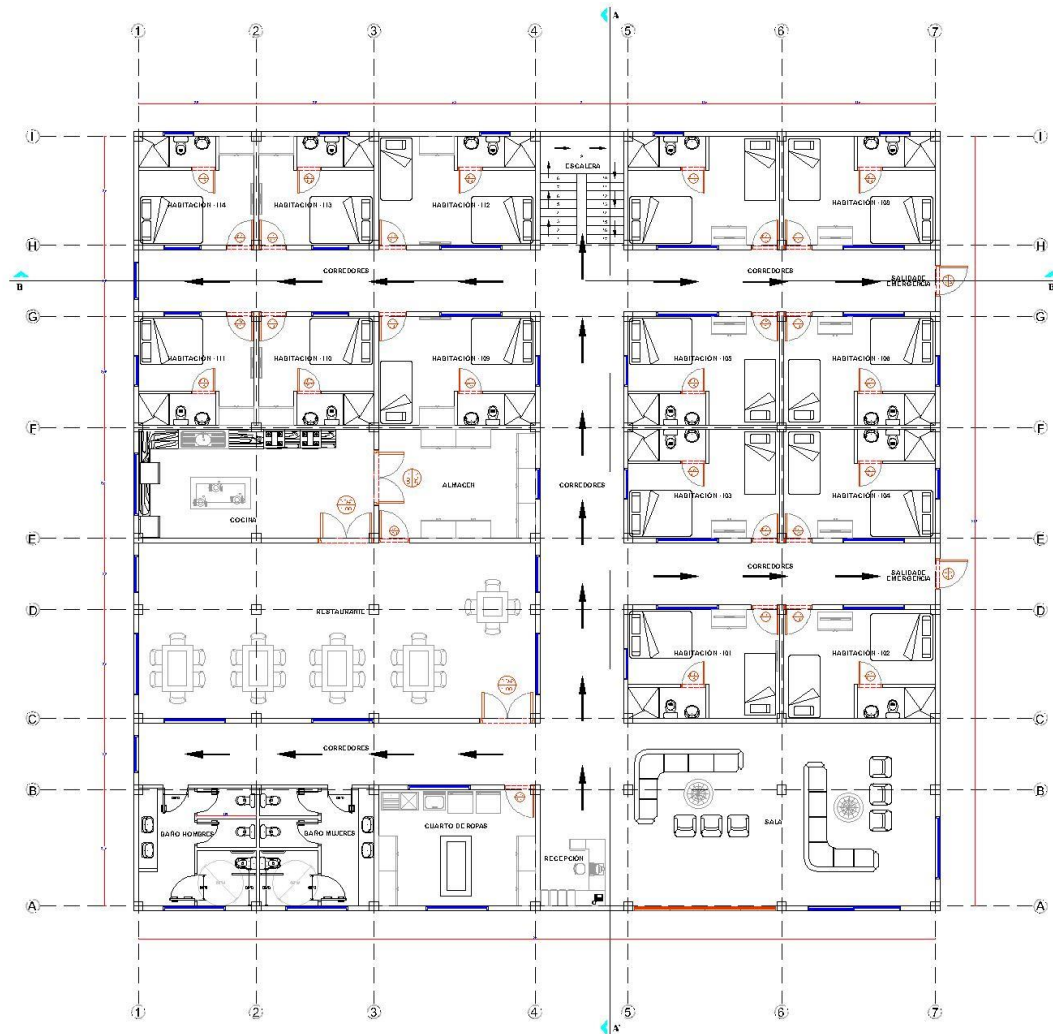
Plano arquitectónico piso 1 del hotel. Fuente propia de los autores.
